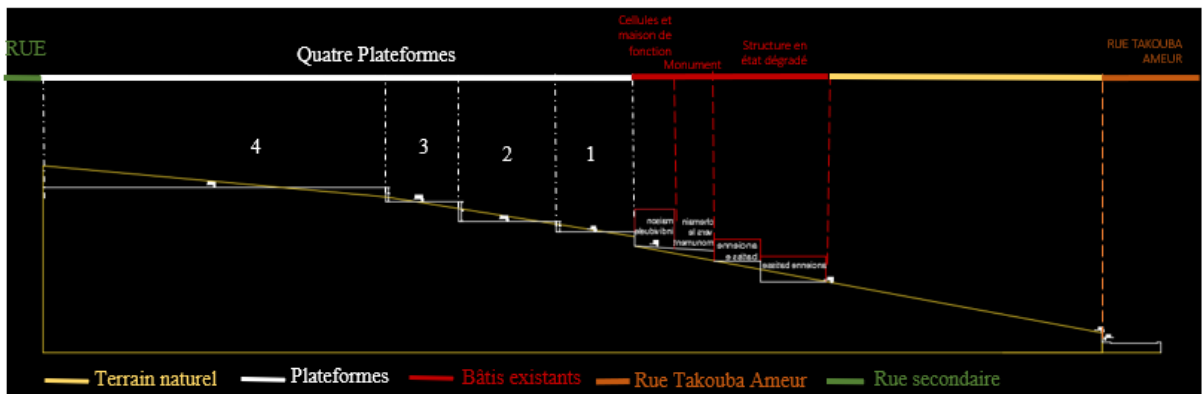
Vue en plan de site d'intervention. Source : auteurs.
